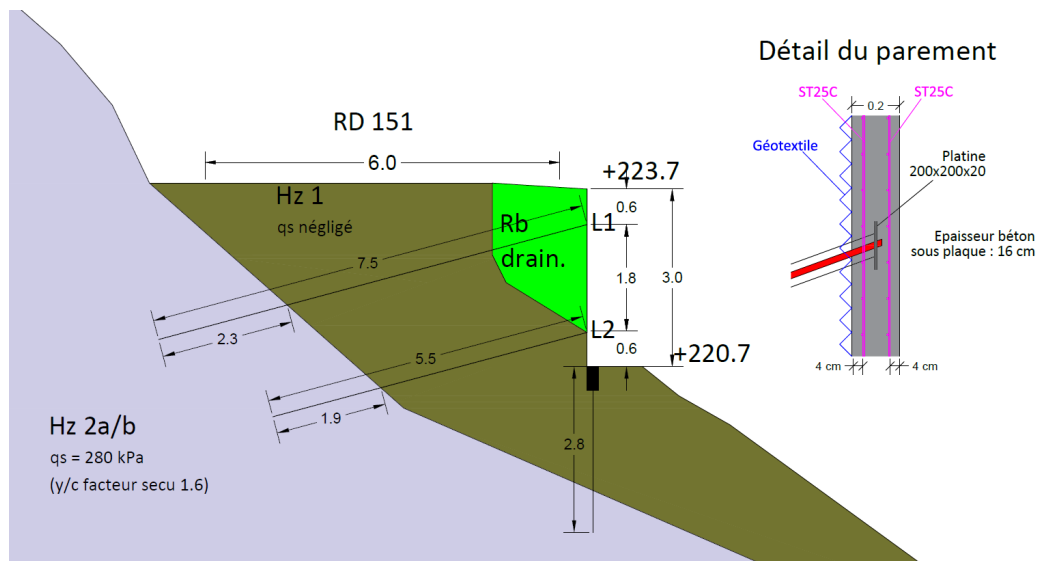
Coupe paroi clouée coffrage perdu extrait G2PRO
